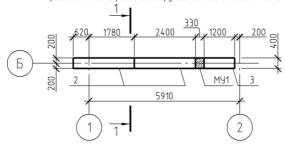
Пример оформления планов для ленточного фундамента мелкого заложения
